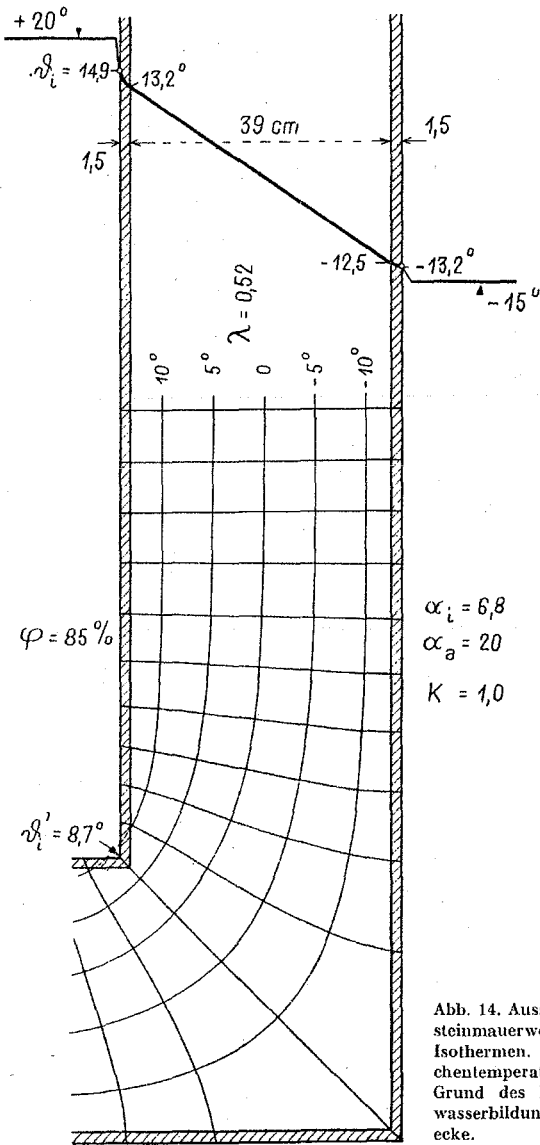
Aussenwanddecke aus Backsteinmauerwerk. Darstellung der Isothermen. Senken der Oberflächentemperatur gegen die Ecke zu. Grund des Beginns der Kondenswasserbildung in der Aussenwanddecke.
